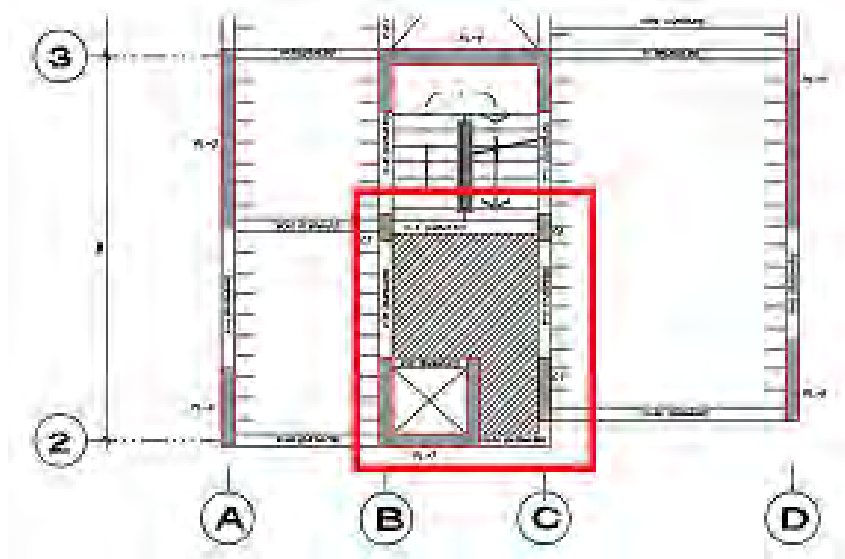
Acercamiento a los ejes 2-3 y B-C en el plano de estructuras
